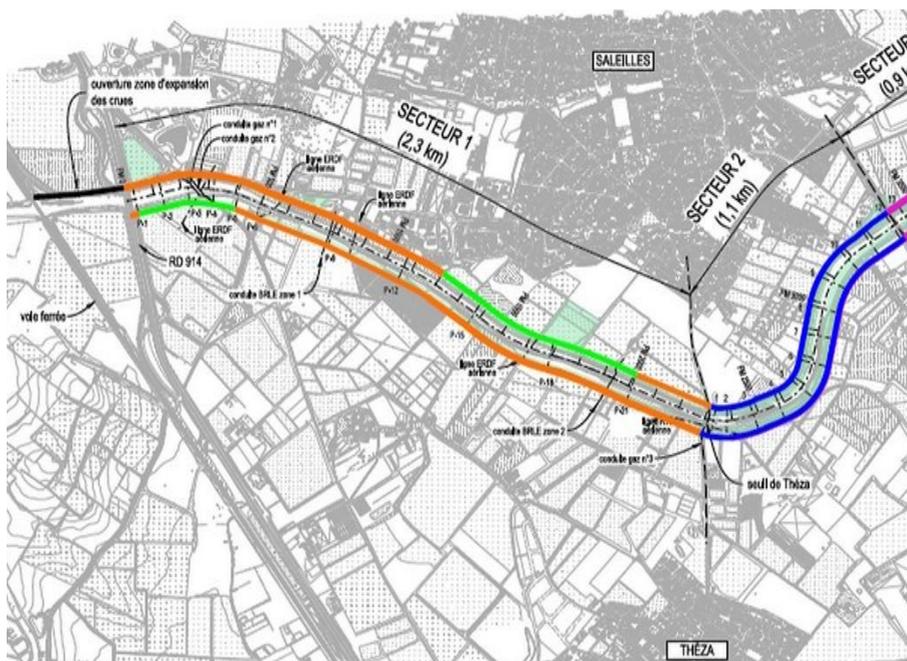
travaux sur les digues, secteurs 1 et 2
